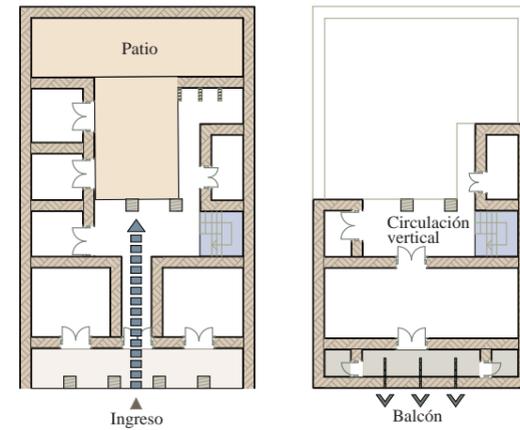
Plantas de vivienda referencial con sistemas vernaculares, Autoría propia, 2025
